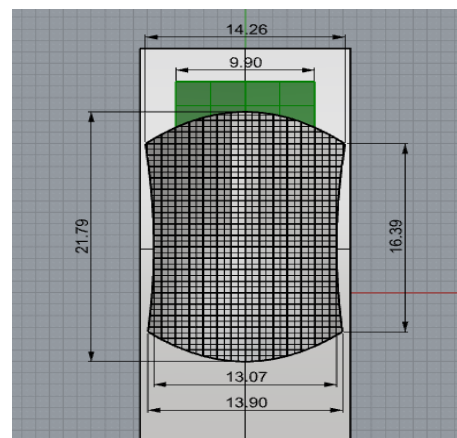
; vista de planta de la cubierta cortada y el terreno.
